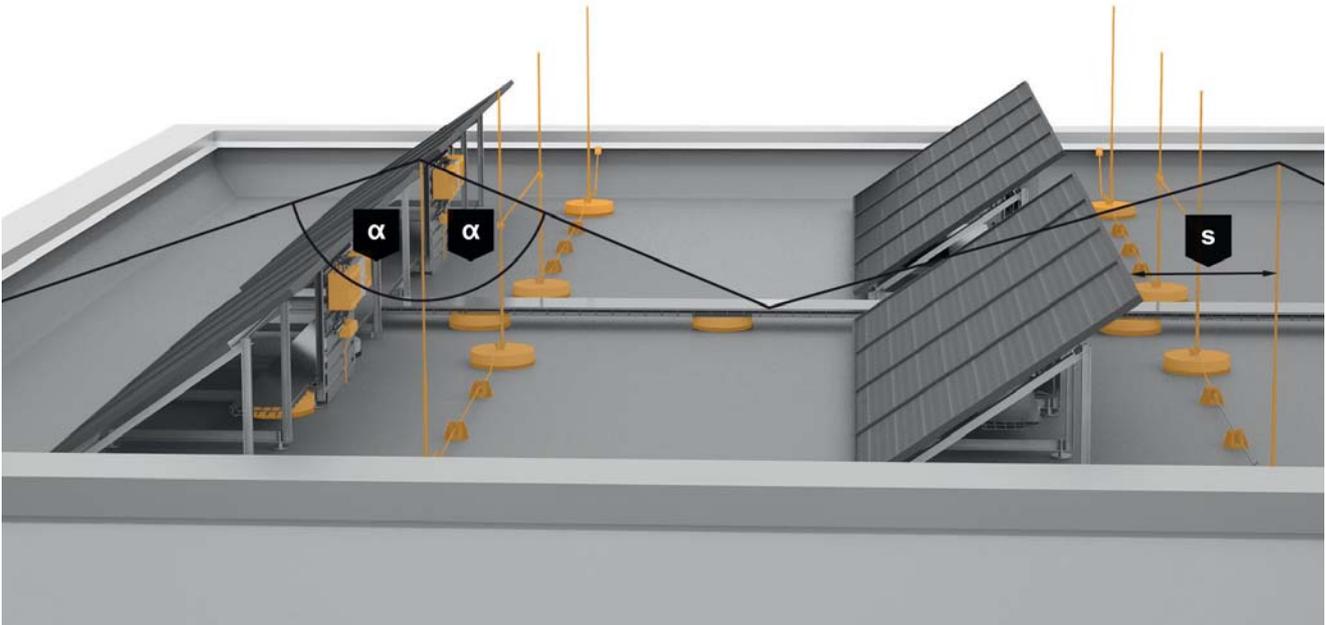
Защитный угол и разделительный интервал на фотогальванической установке
